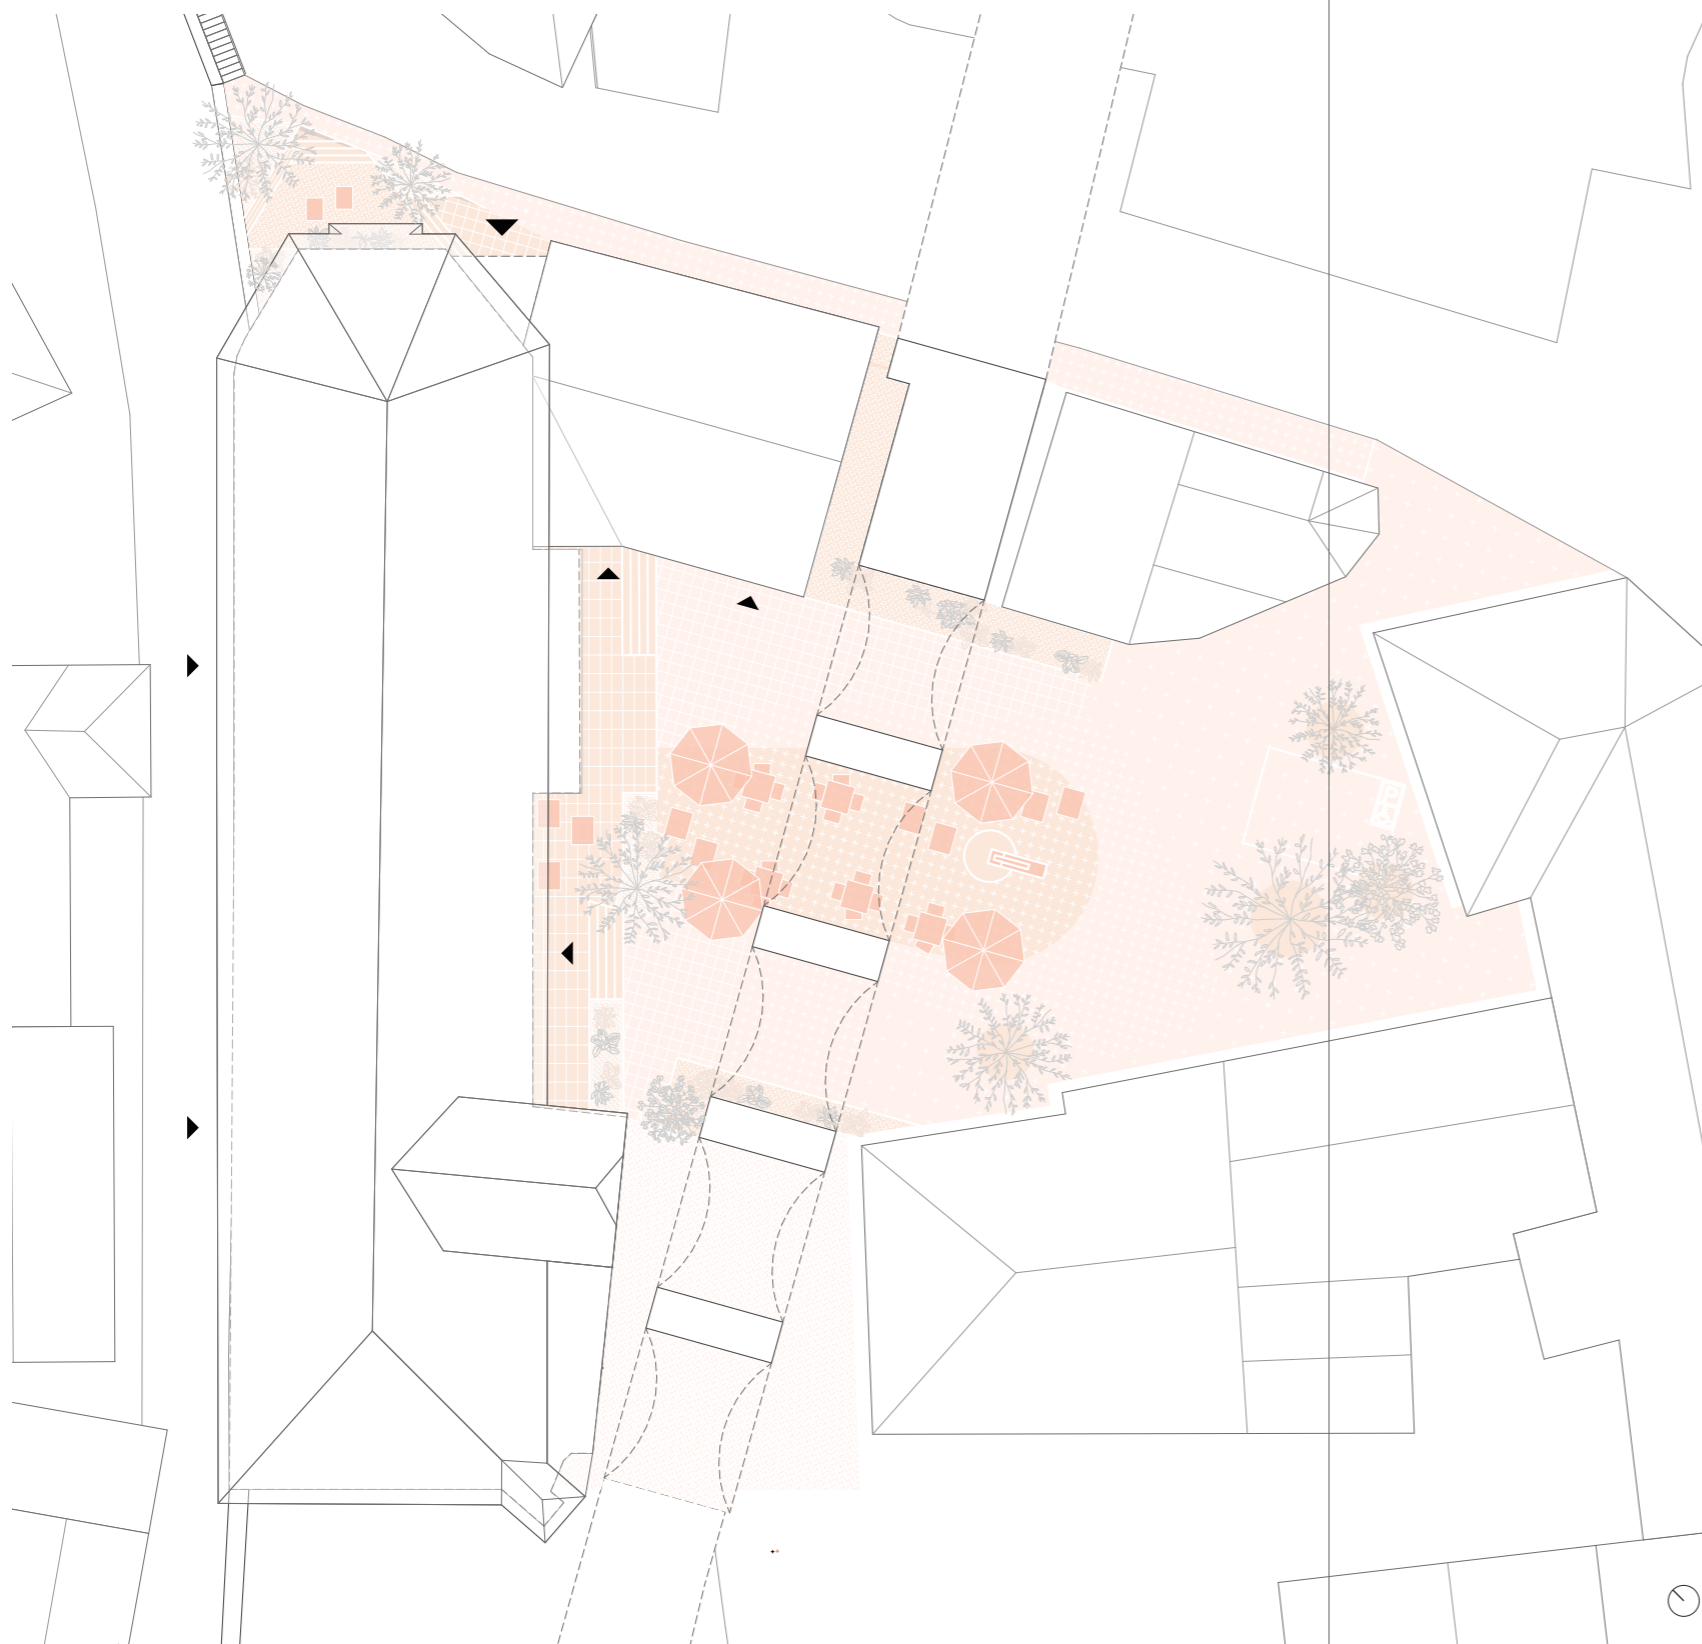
Entwurfsplan Außenraum/Platzgestaltung
